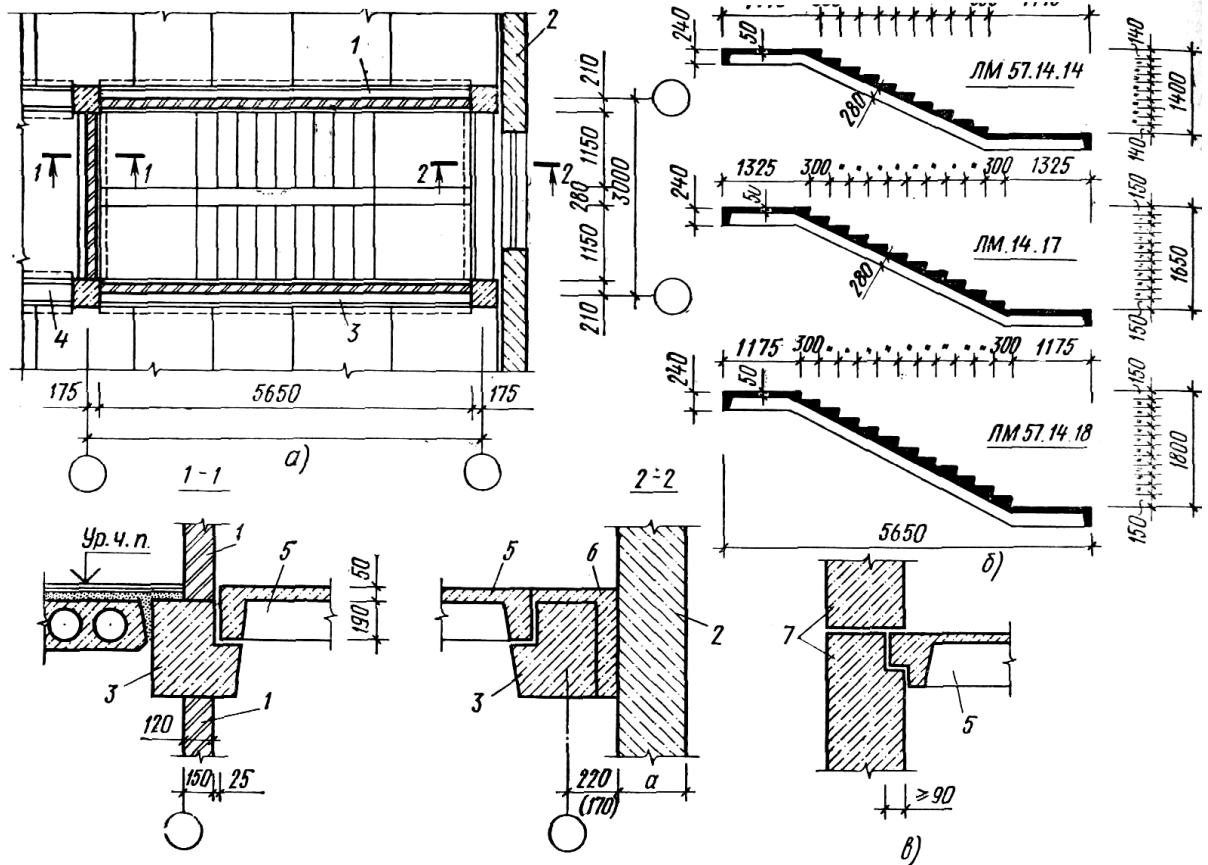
а – план лестницы в каркасном здании; б – типы лестничных маршей для разных высот этажей; в – вариант опирания лестничного марша в крупнопанельном бескаркасном здании; 1 – кирпичные стены лестничной клетки; 2 – стеновая панель; 3 – ригель с одной полкой (марки РО); 4 – то же, с двумя (марки РД); 5 – полуплощадка лестничного марша; б – бетон замоноличивания
